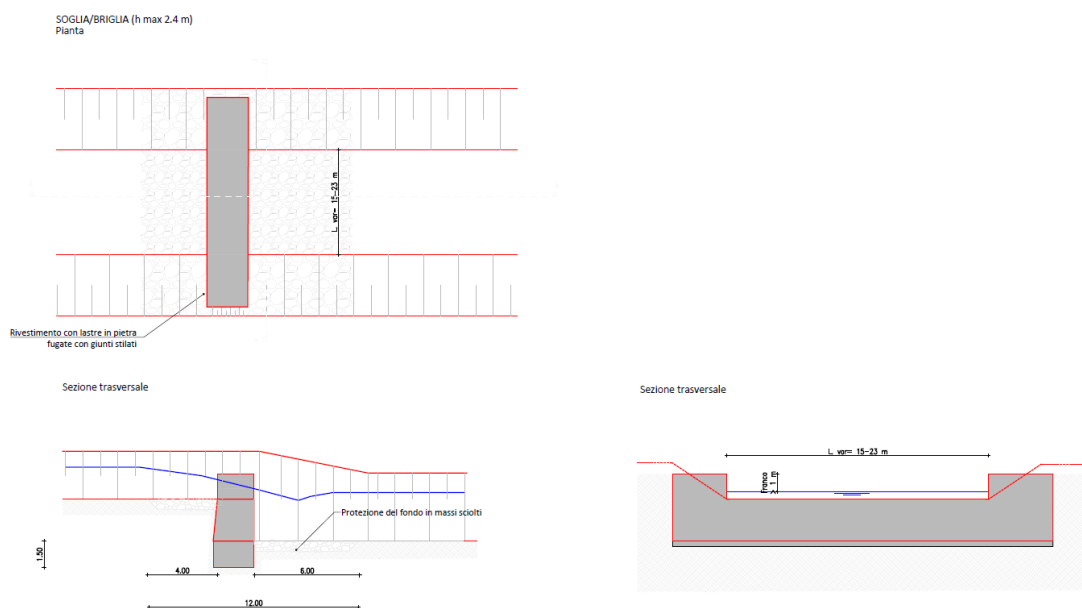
Pianta, sezione trasversale e sezione longitudinale tipo della soglia/briglia previste nella soluzione di progetto.
